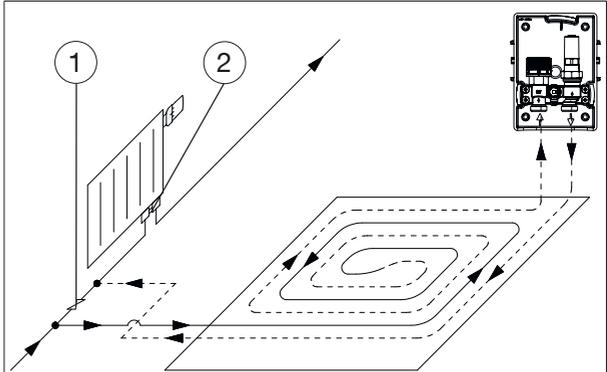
Anschluss mit Bypass-Ventil und Heizkörperverschraubung mit Bypass
